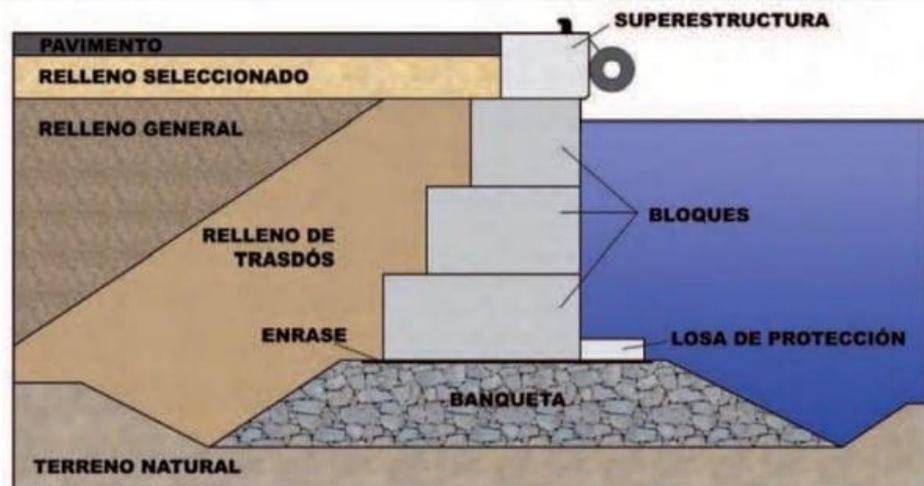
Muelles de bloques prefabricados. (Structuralia, 2024)
